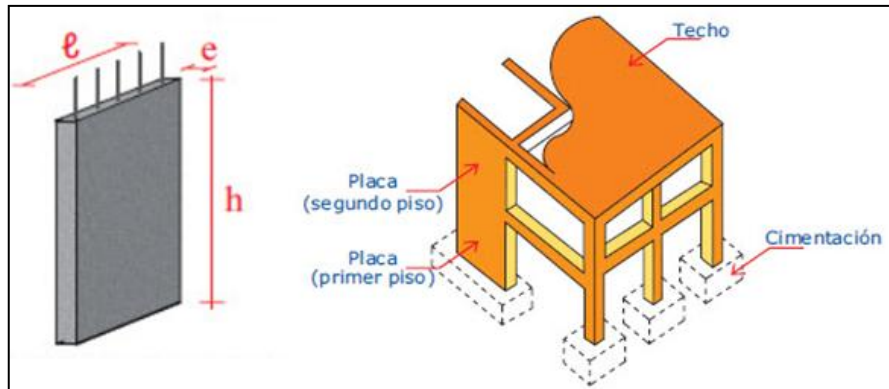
MUROS ESTRUCTURALES – DISPOSICIÓN.
